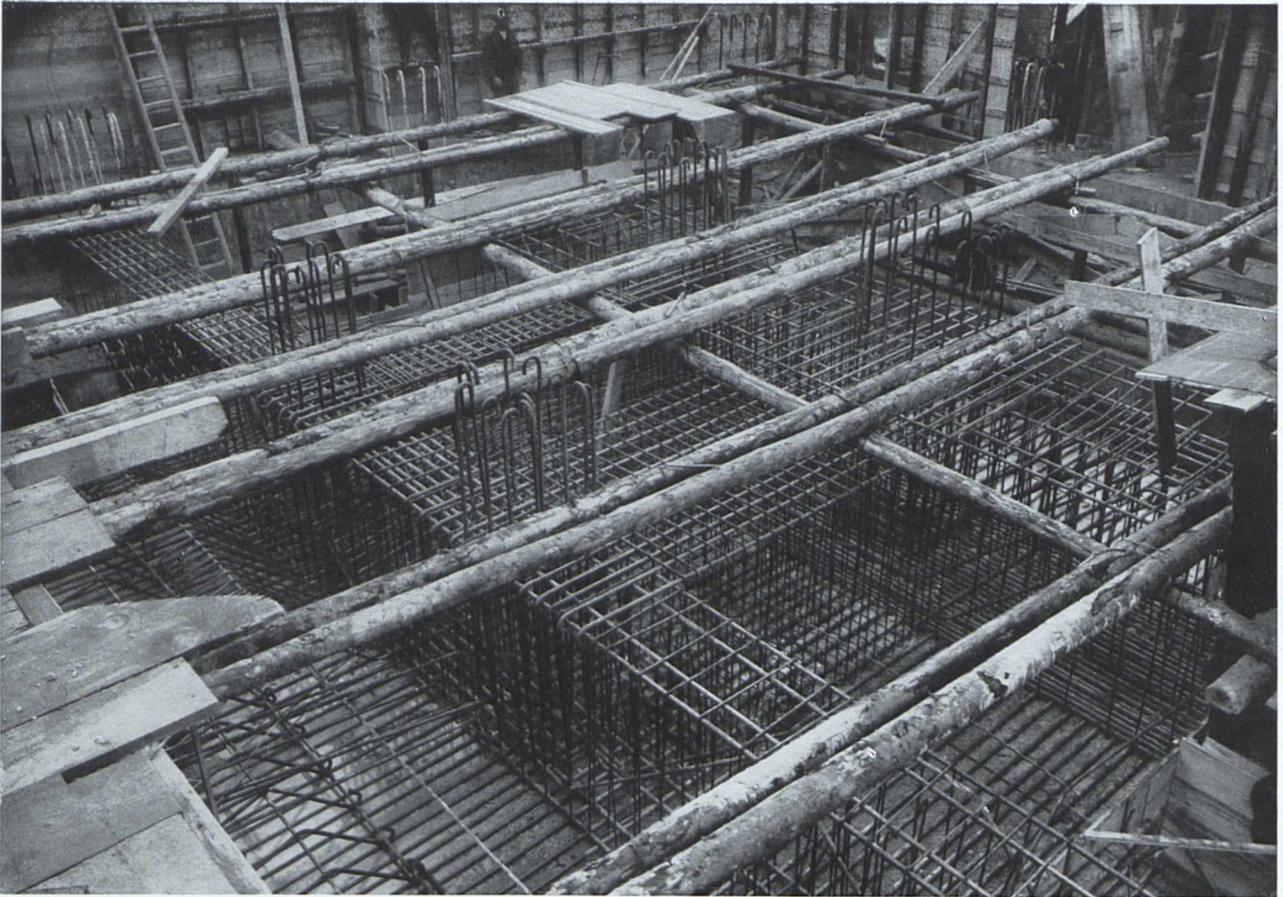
Bauausführung: Karl Stöhr, Bauunternehmung, München, Schwanthalerstraße 11
